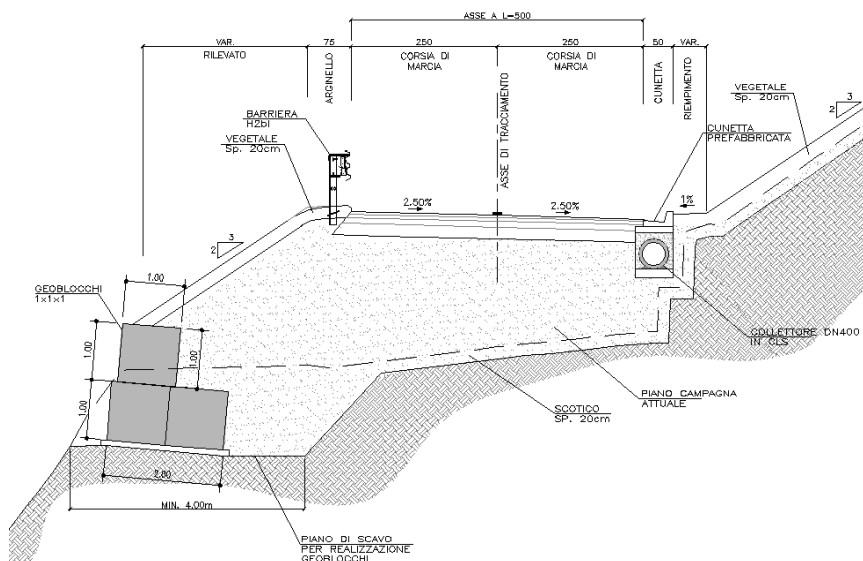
Muri in geoblocchi – Sezione tipo
